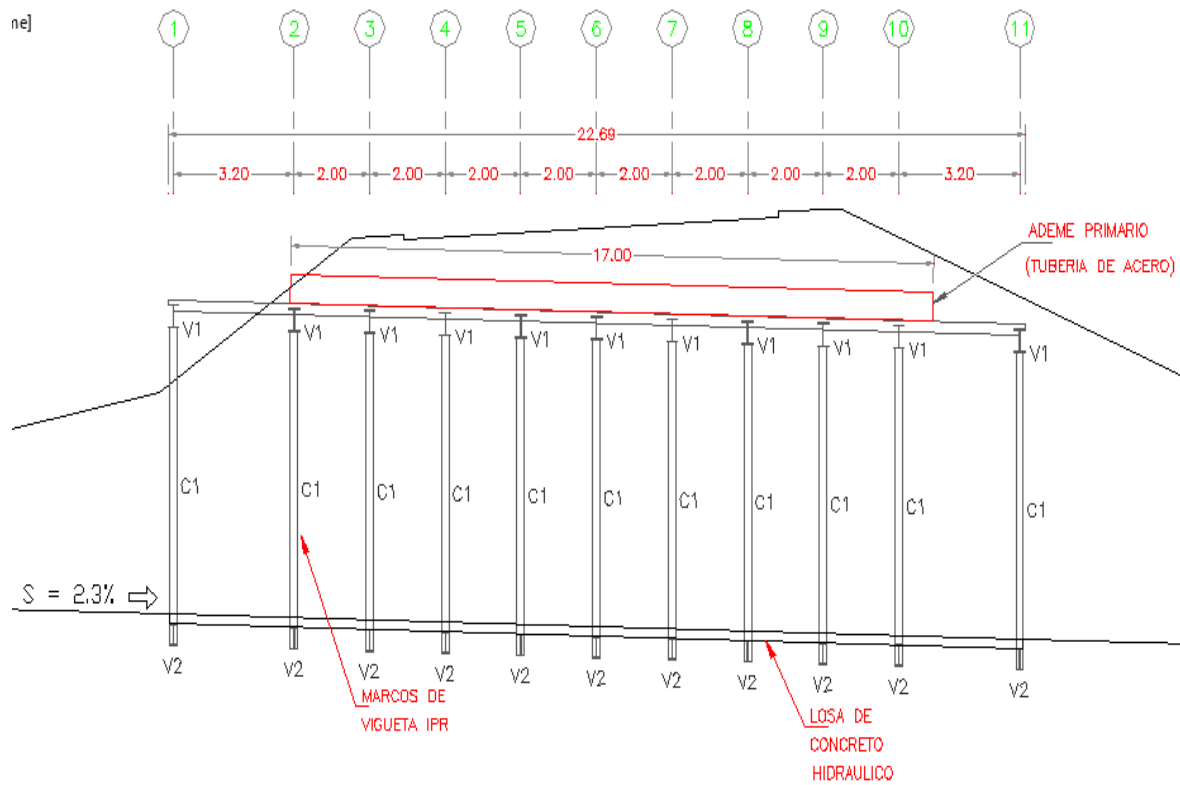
Ubicación de vigas de acero (corte longitudinal)
